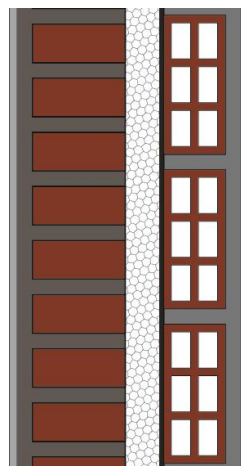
Solución constructiva para paredes exteriores tipo 1.
